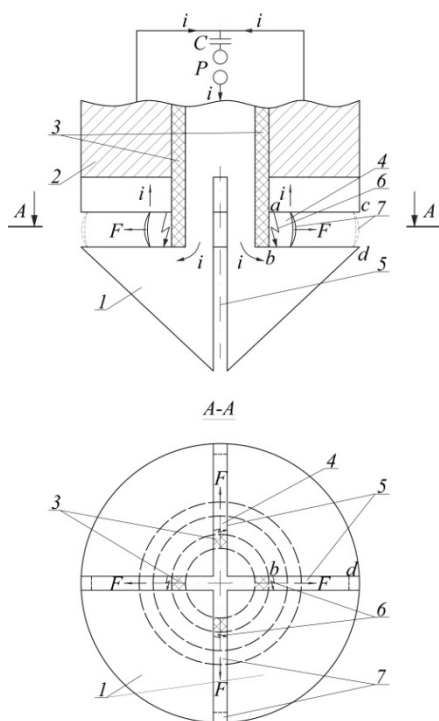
Разрядное устройство для изготовления набивной сваи:
